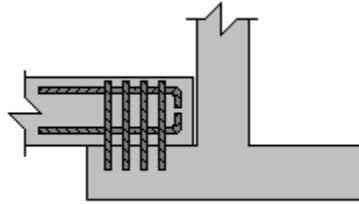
Apoyo de la Viga de Enlace en la Zapata Central
